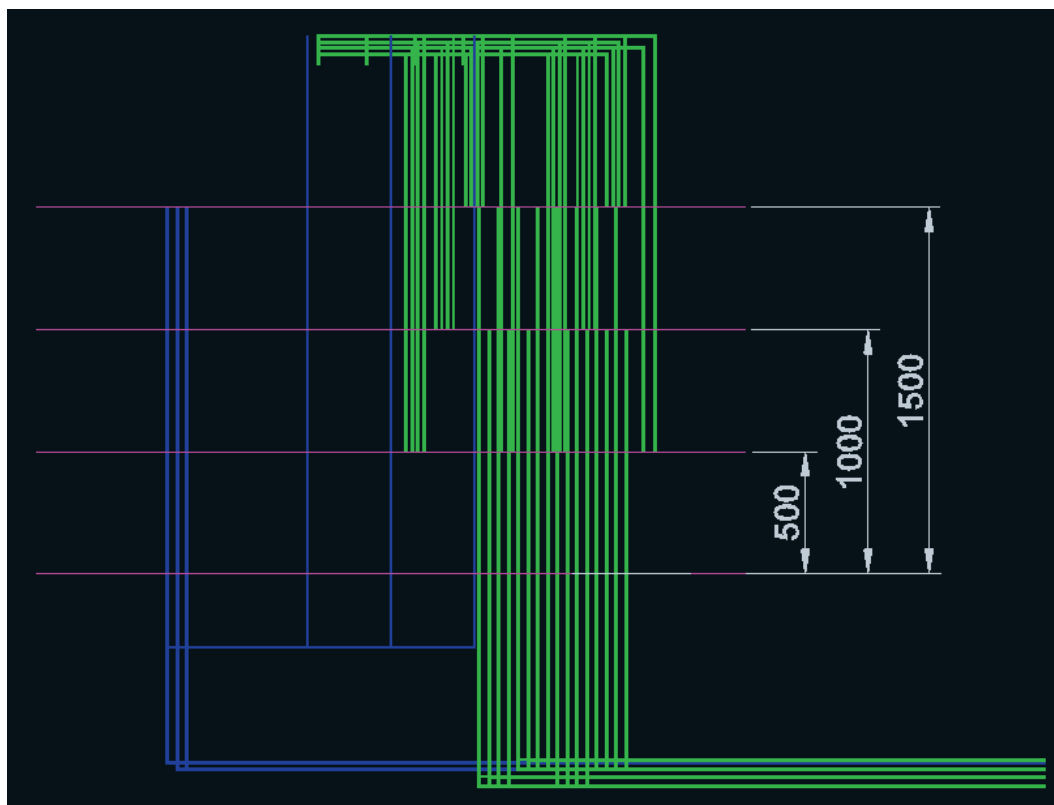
Vista en perfil de la instalación (2L+2T [Sup]) (cotas en mm).
